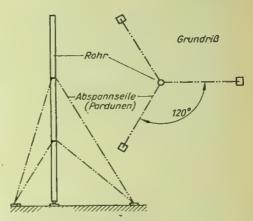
Abgespannter Stahlrohrmast
